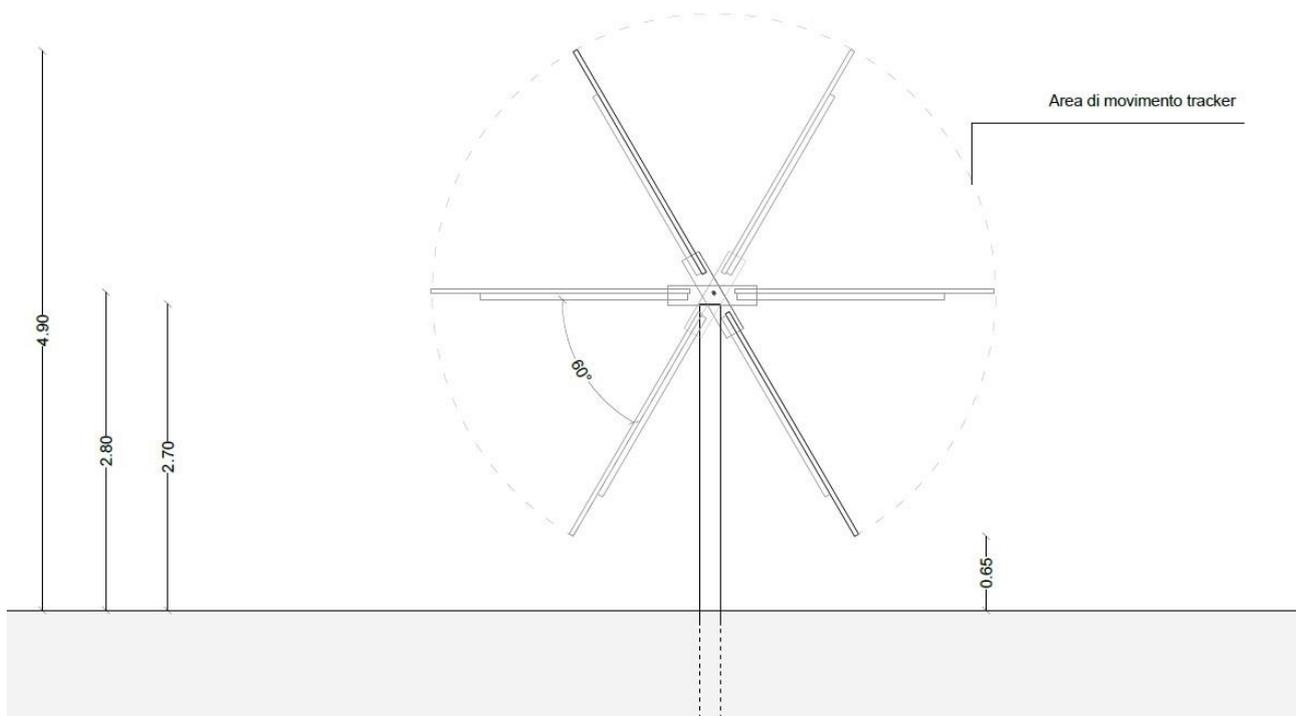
Strutture di sostegno e sistema di inseguimento solare
